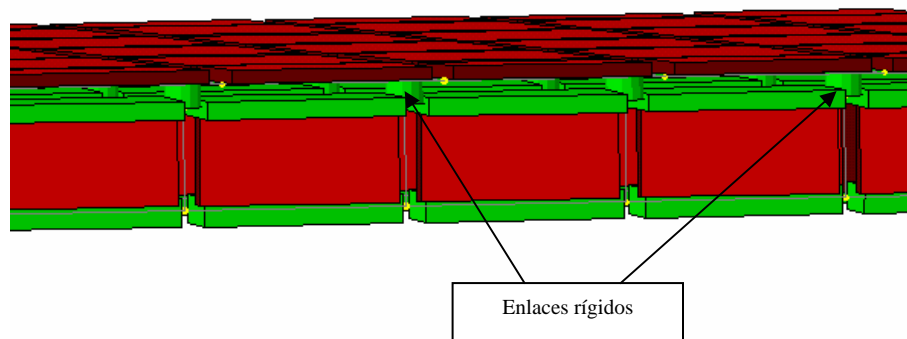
Unión entre la losa y viga mediante los enlaces rígidos
